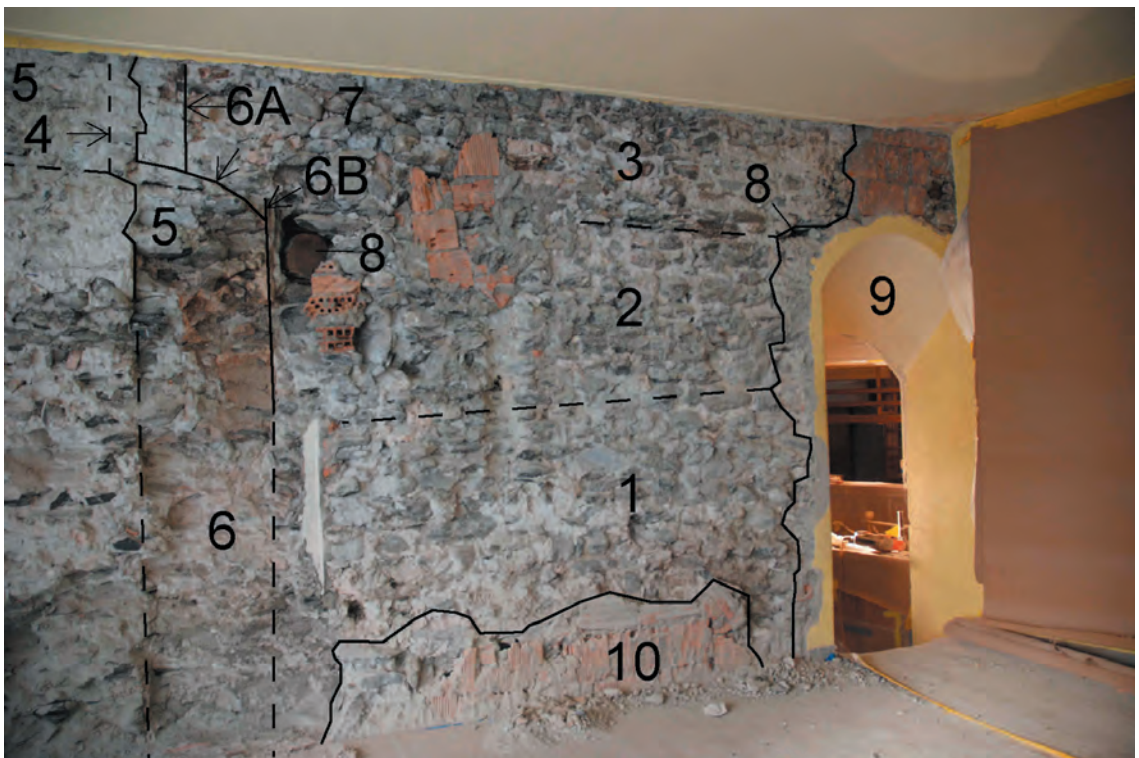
Rez-de-chaussée, restaurant salle nord, mur sud, partie ouest (2009).
